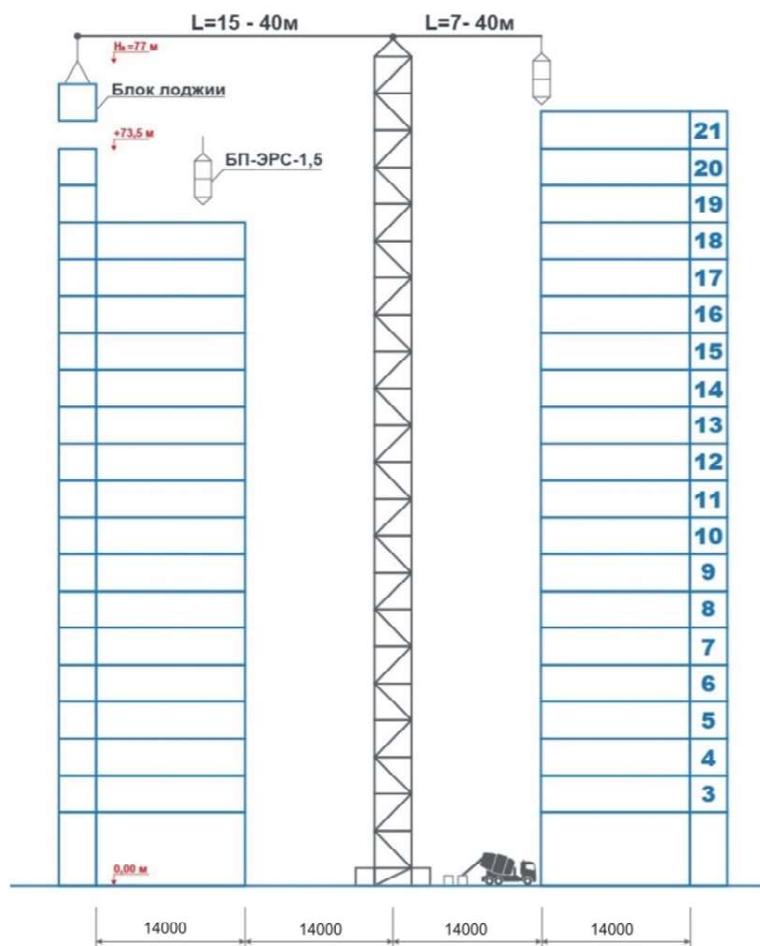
Сечение по этажам жилого дома для возведения в жестких погодных условиях.
